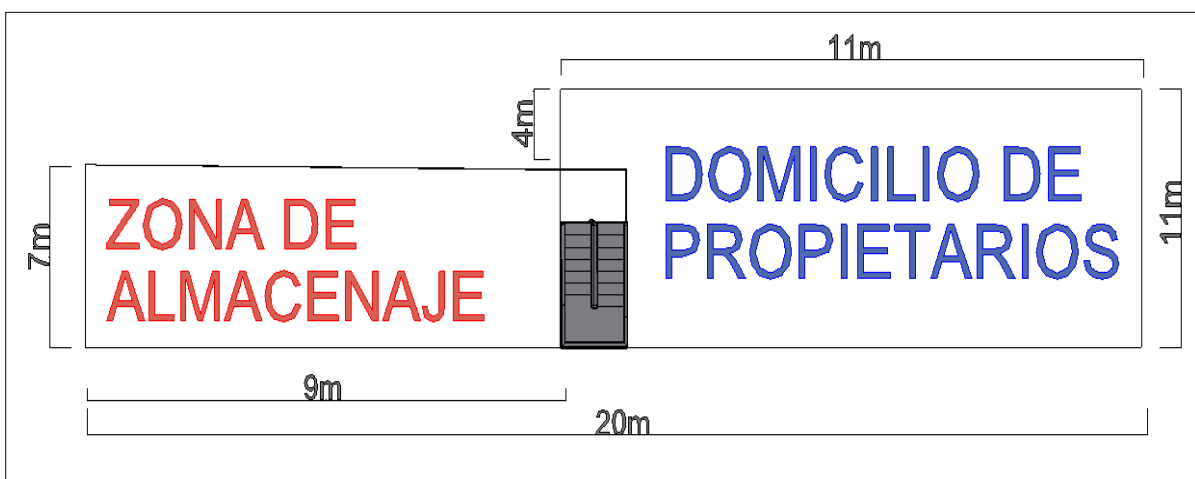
Vista superior y dimensiones de la segunda planta (plano 1)
